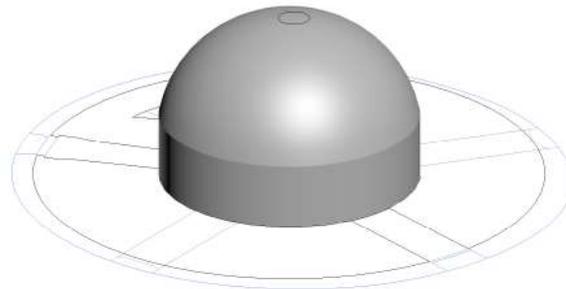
Rivoluzione del profilo di sezione dell'ambiente interno rispetto all'asse Z.
